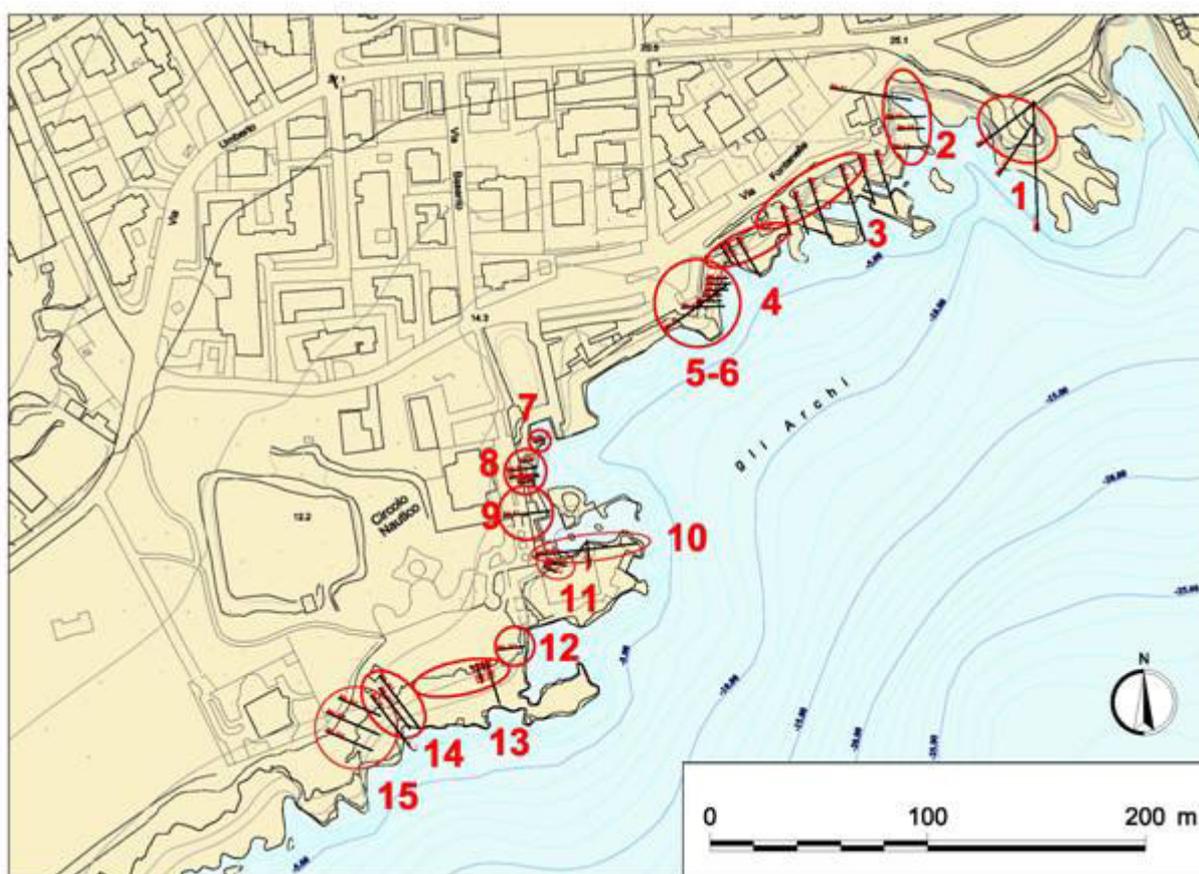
Planimetria con ubicazione dei siti oggetto di intervento
